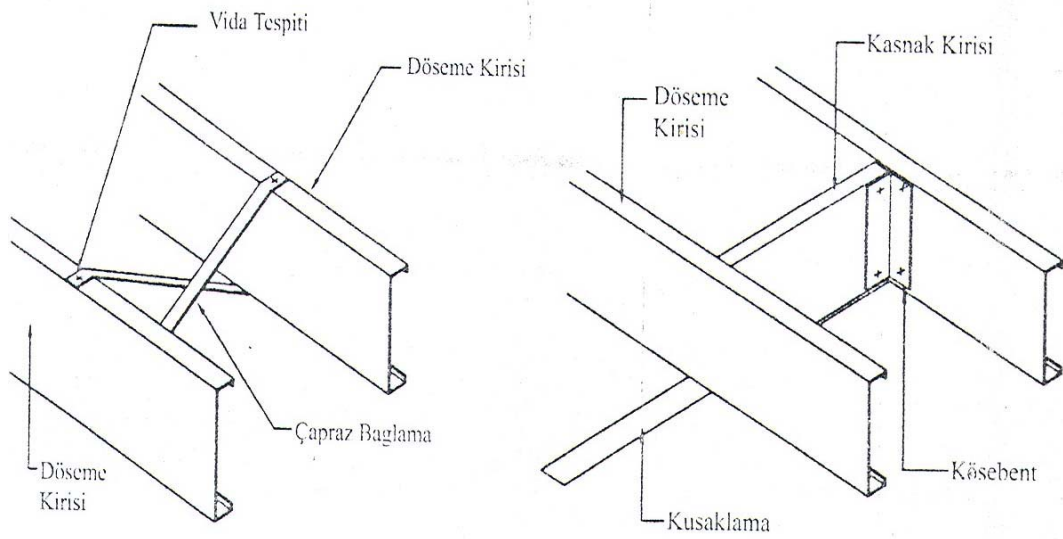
Döşeme kirişinde ek yapılması (NASFA, 2000)
